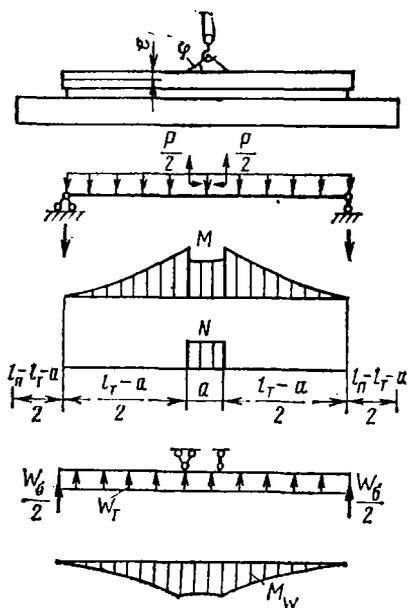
Схема приложения горизонтальных нагрузок к траверсе и эпюры усилий M , N и M_w .
